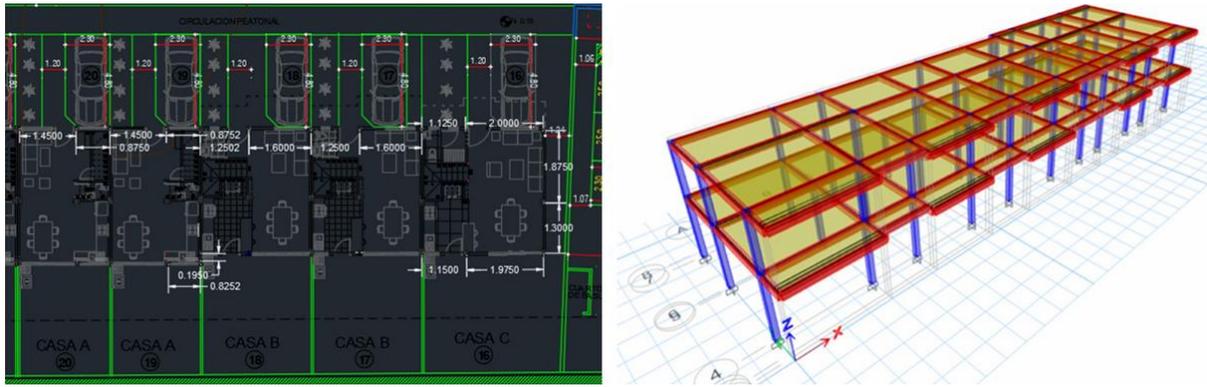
Planos Arquitectónicos y Modelo Estructural del Proyecto en ETABS
